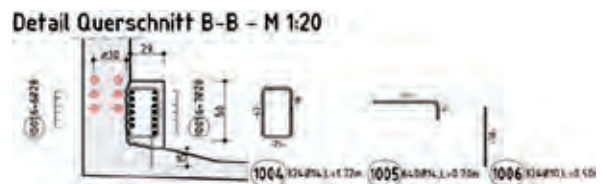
Querschnittsergänzung mit Betonstahlbewehrung zur Verbesserung des Ankündungsverhaltens Zeichnung: aus [32]
